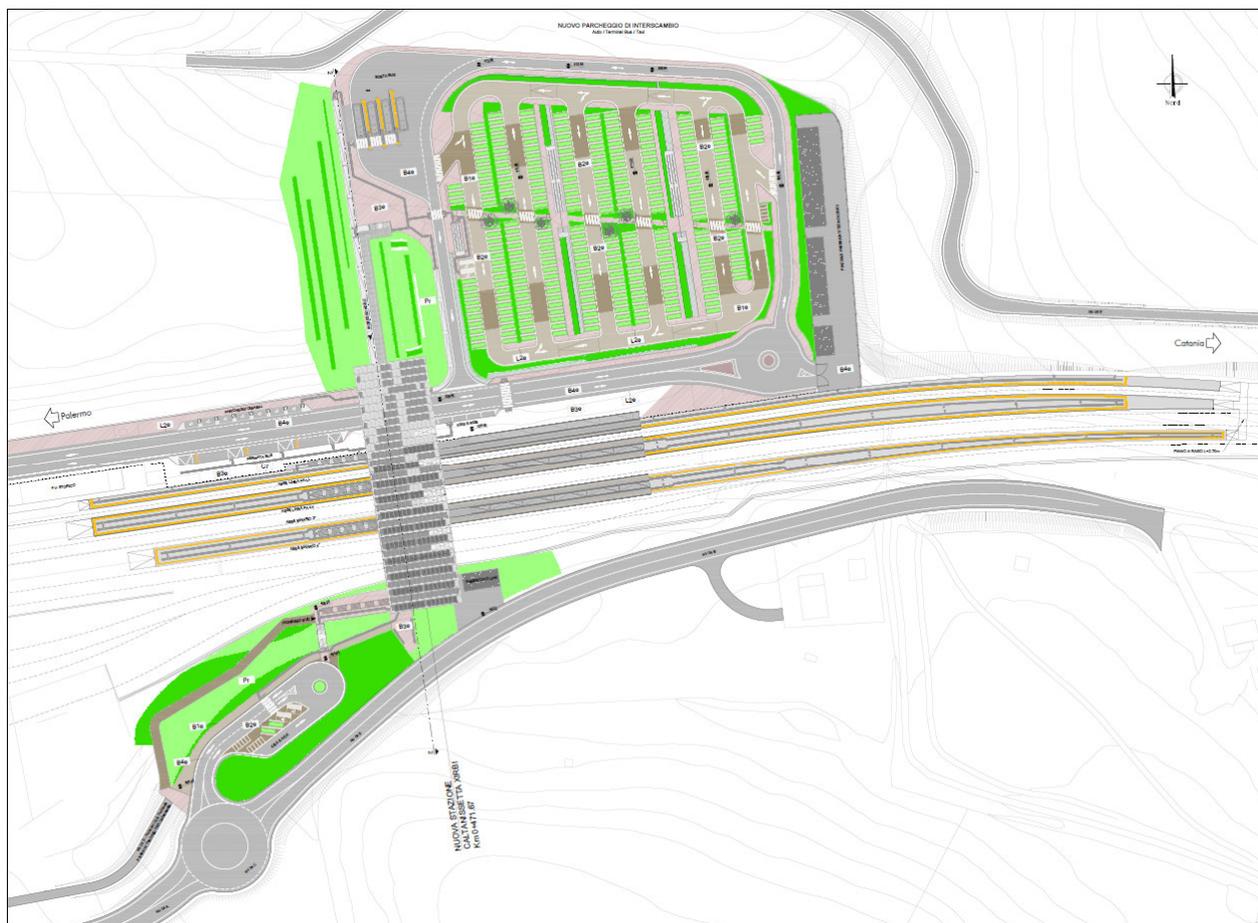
Stazione Caltanissetta Xirbi - Planimetria assetto generale
